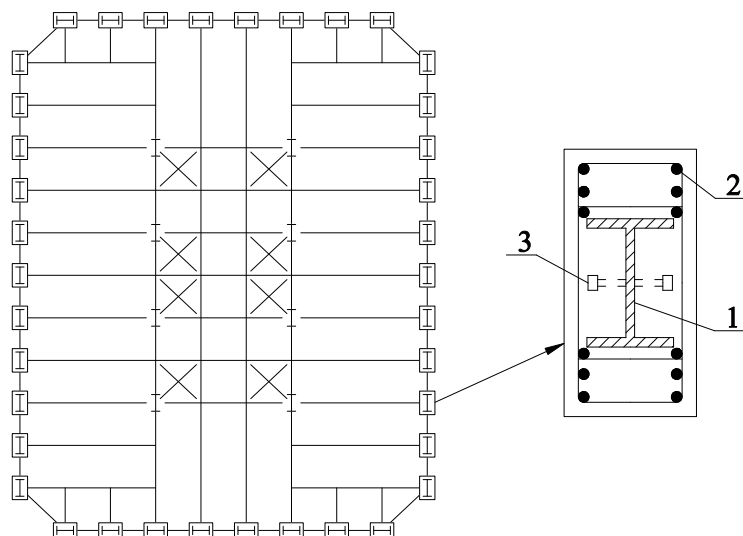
Поперечное сечение несущего стенового каркаса высотных зданий запроектированных американской фирмой SOM [7]
